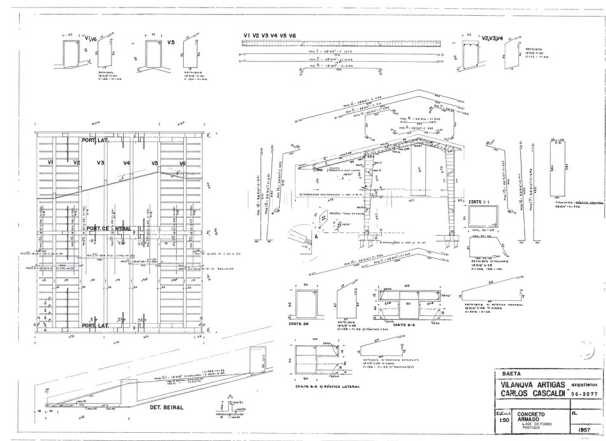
| Projeto estrutural - laje e pórticos - Projeto Executivo da Casa Olga Baeta
